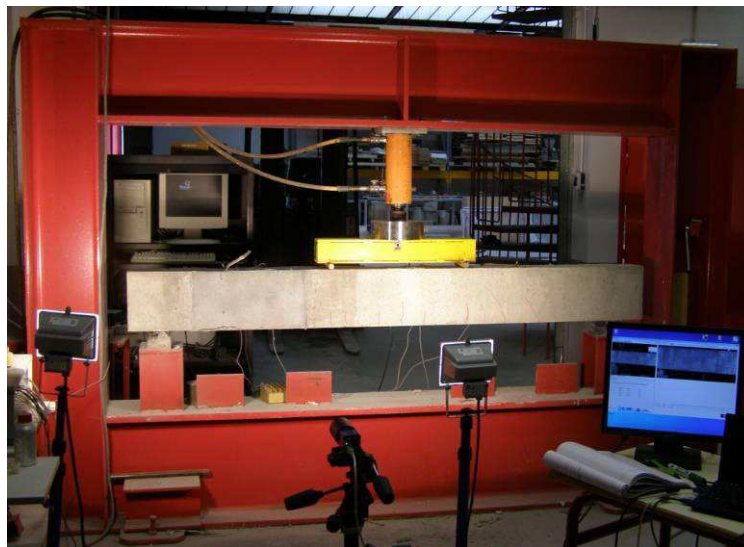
Illustration du dispositif d'essai et de l'instrumentation (le capteur LVDT ne figure pas sur cette photo)
